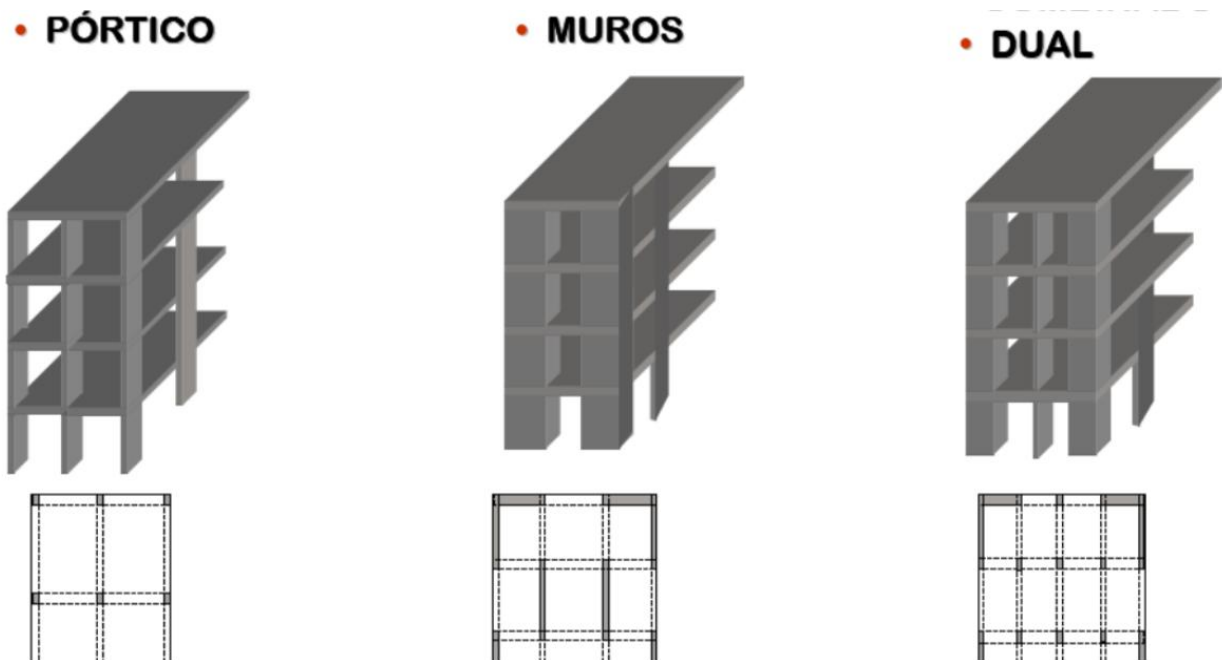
Sistemas estructurales más comunes en concreto armado. Fuente: sioingenieria.
